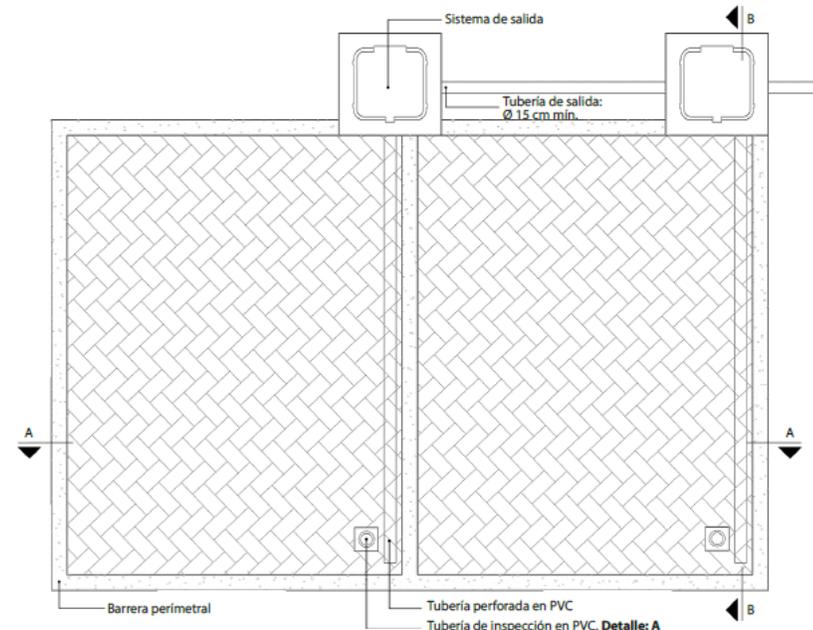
Planta: Pavimento permeable de tipo adoquines entrelazados
